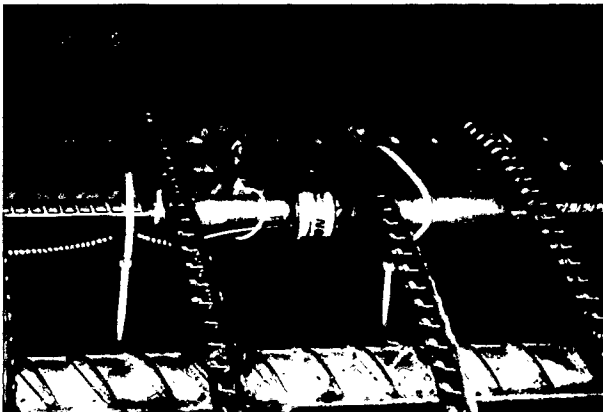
Detailaufnahme eines Bewehrungsmessfühlers, der an einem Längseisen des Bewehrungskorbes befestigt ist.
